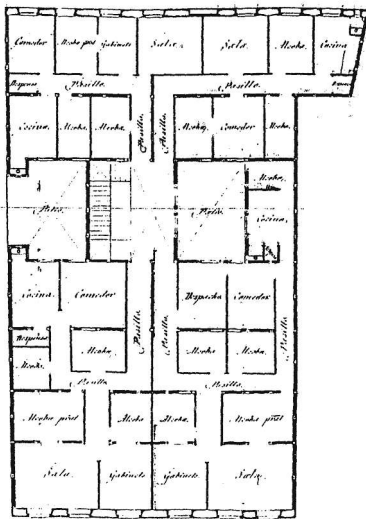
Calle de la Lista 22, Grundriss des 1., 2. und 3. Obergeschoss
